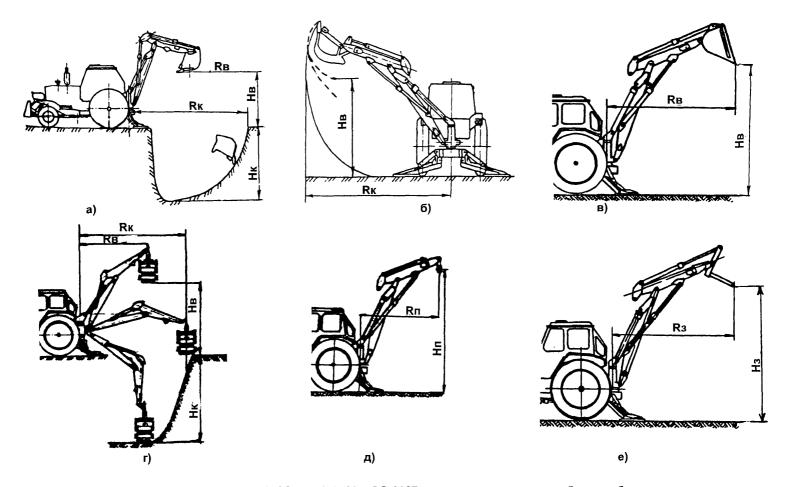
Параметры экскаваторов ЭО-2621 В-3, ЭО-2626 и ЭО-2627 с различными типами рабочего оборудования: а - обратная лопата; б - прямая лопата; в - погрузочный ковш; г - жесткий грейфер; д - крюк; е - погрузочные вилы
